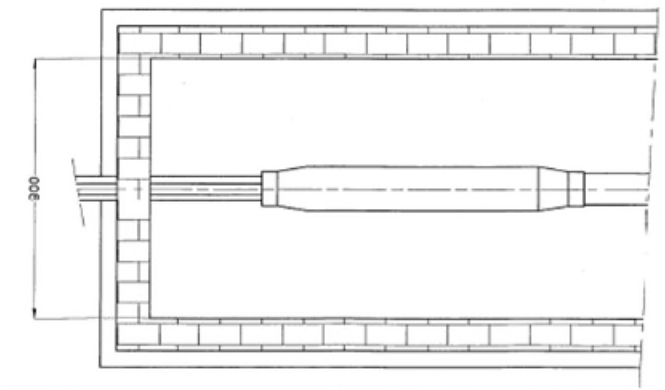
VU EN PLAN D'UNE CHAMBRE D'ATTERRAGE
